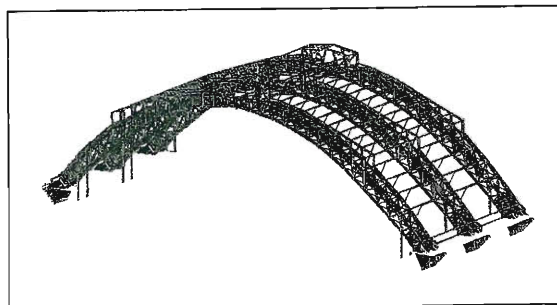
Sängerbundfesthalle Dresden, 1925, Spannweite 78m, Ausführung: Zimmermeister Noack, CAD- Zeichnung
